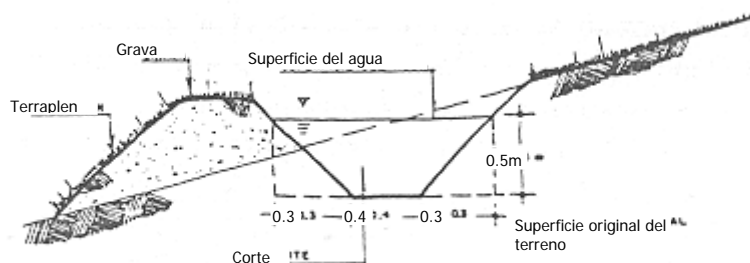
Detalle de la sección transversal del canal trapezoidal.
